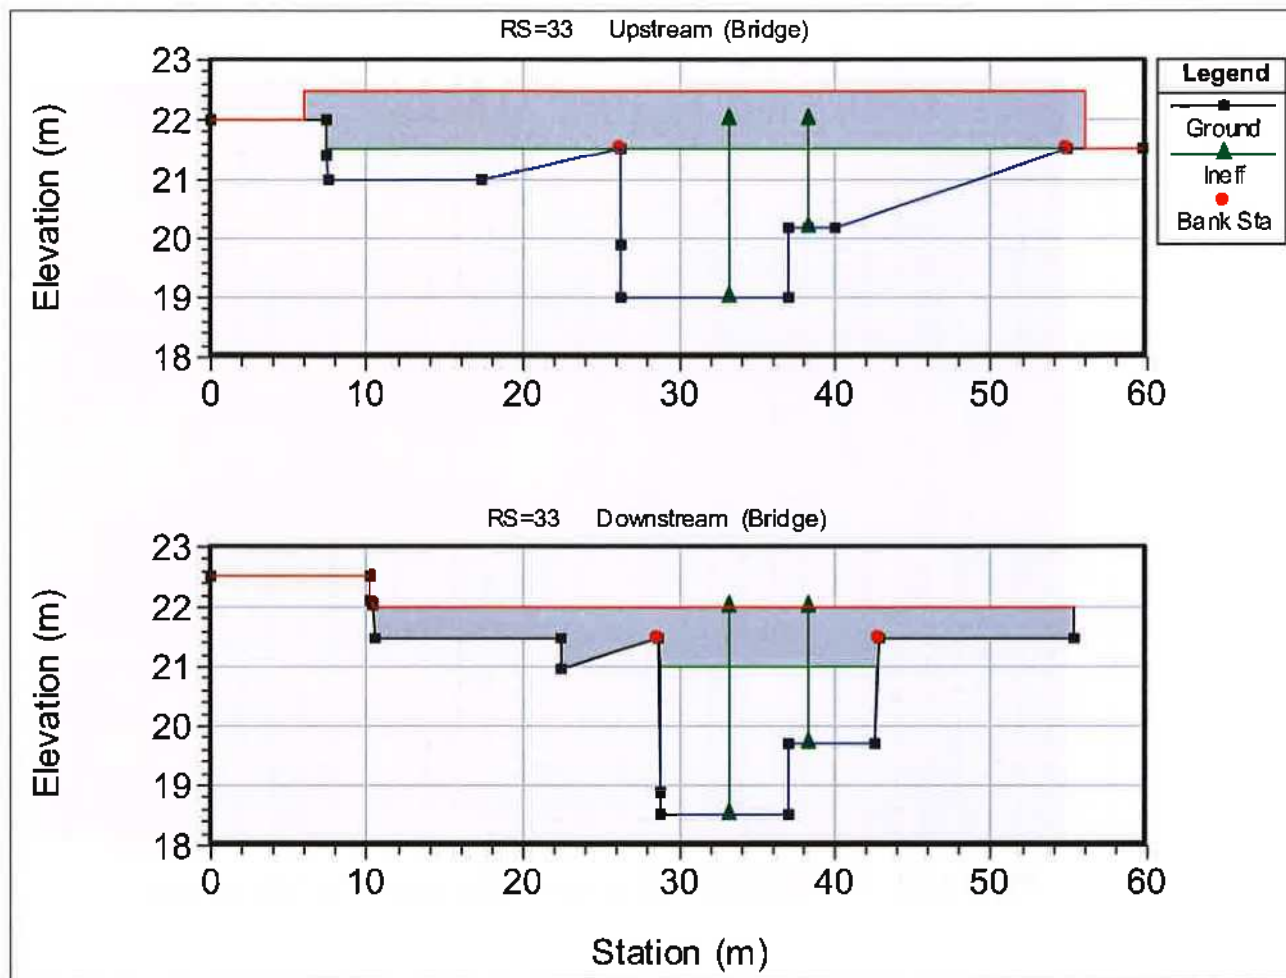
Perfil longitudinal del Drenaje 5 en la vía de acceso a Puerto Barú.
